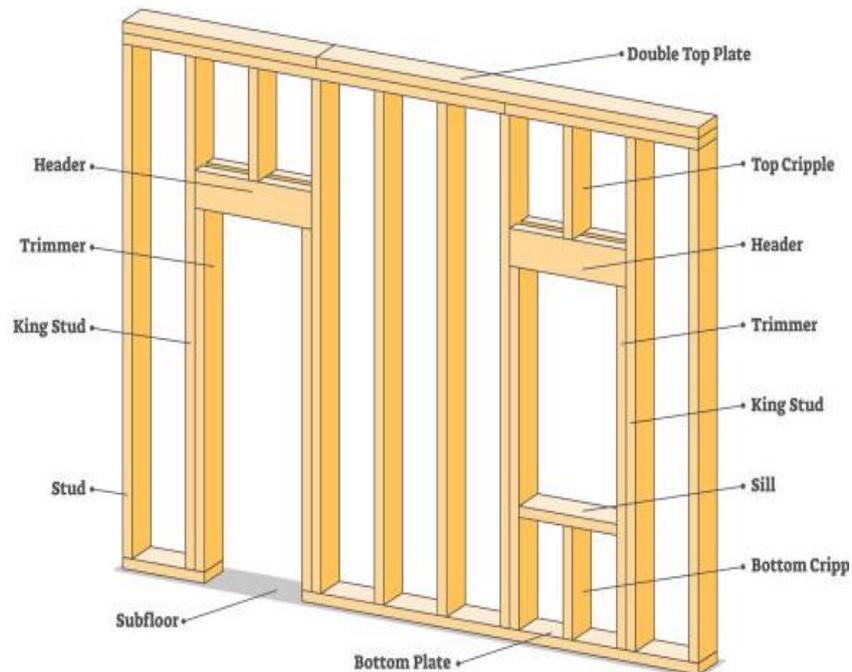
Imagen sobre técnica de construcción [Imagen]. (2021).
